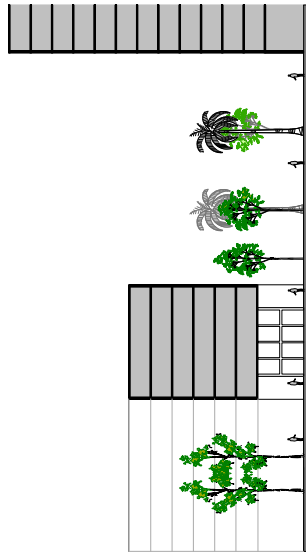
Planta Rambla Poblenou. Fuente: Elaboración propia.
